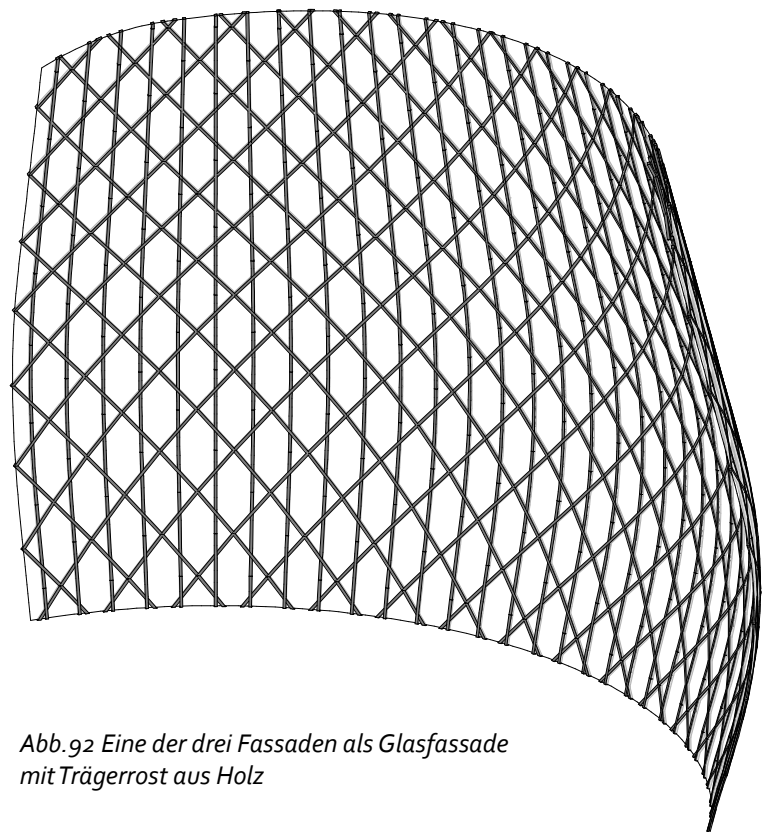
Eine der drei Fassaden als Glasfassade mit Trägerrost aus Holz
